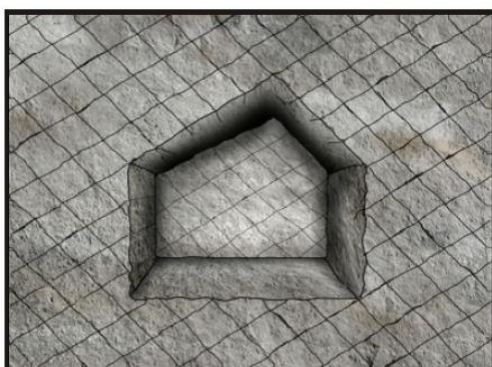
Muestra diversas formas de excavaciones en función del terreno condicionado por planos geológicos estructurales, y las tipologías de cuñas que se originan (S.N.M.P.E, 2004).
